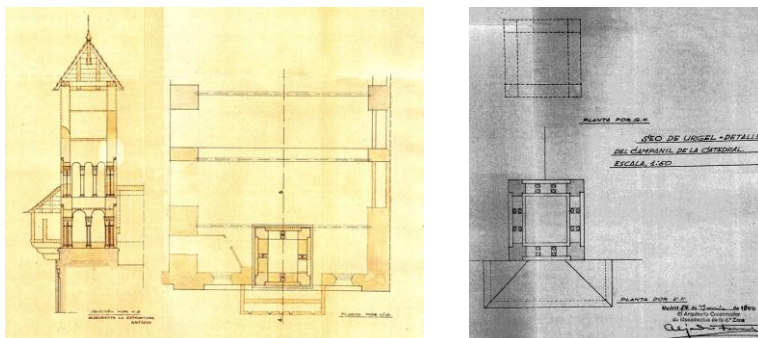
Seo de Urgel. Cathedral de Santa María AAFV. Sección y planta del campanil. Planos de proyecto. A. Ferrant
